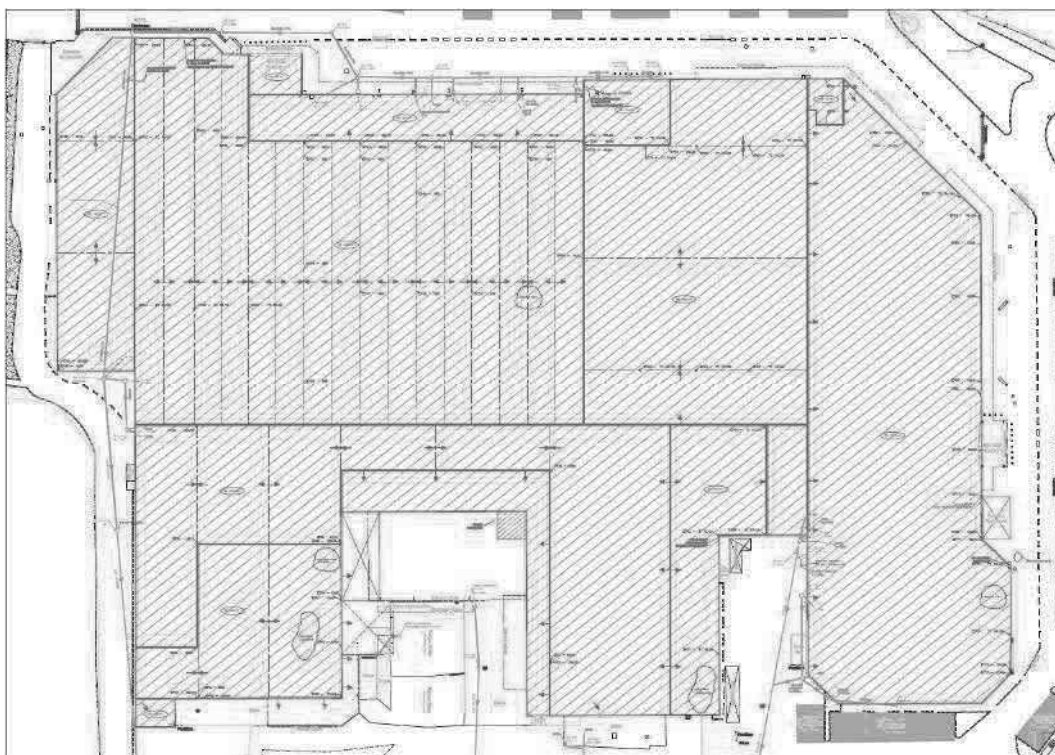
Réseau pluvial de collecte des eaux de toiture
